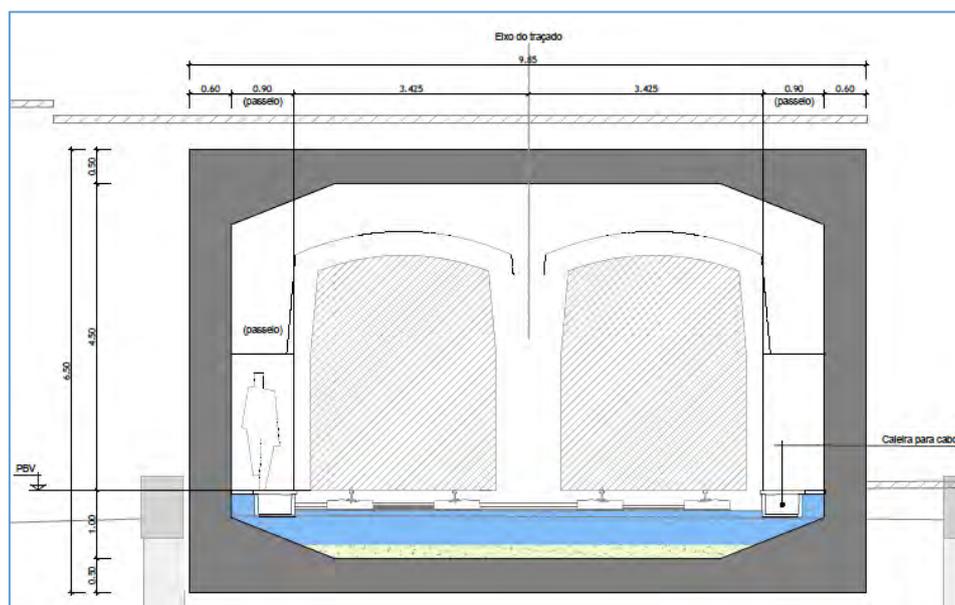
Secção Tipo do Túnel do Metro (sem escala)
